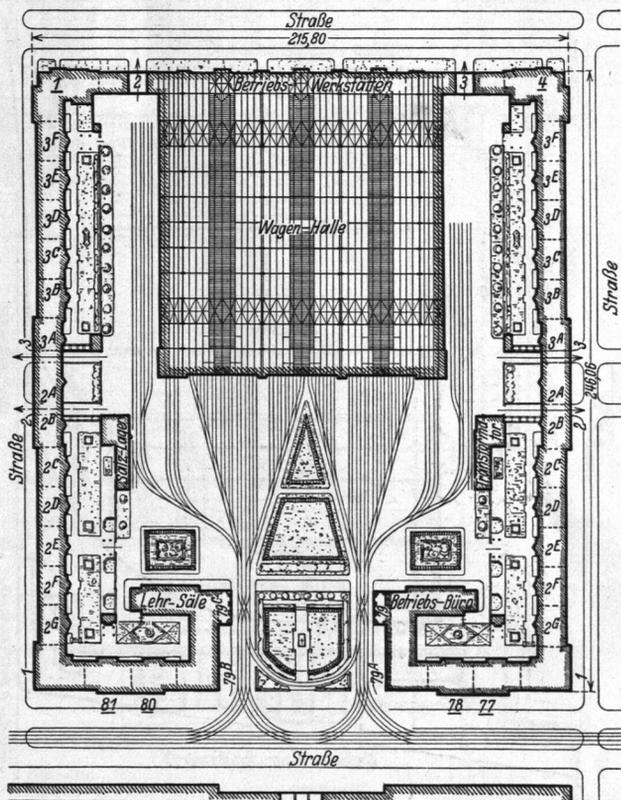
Der Lageplan eines Straßenbahnhofs wird von der Gleisanlage beherrscht. (Das Bild ist der Veröffentlichung von G. Mensch „Der neue Bahnhof Müllerstraße der Berliner Straßenbahn-Betriebs-G. m. b. H.“ Baug. 1928, Heft 21 entnommen.)
